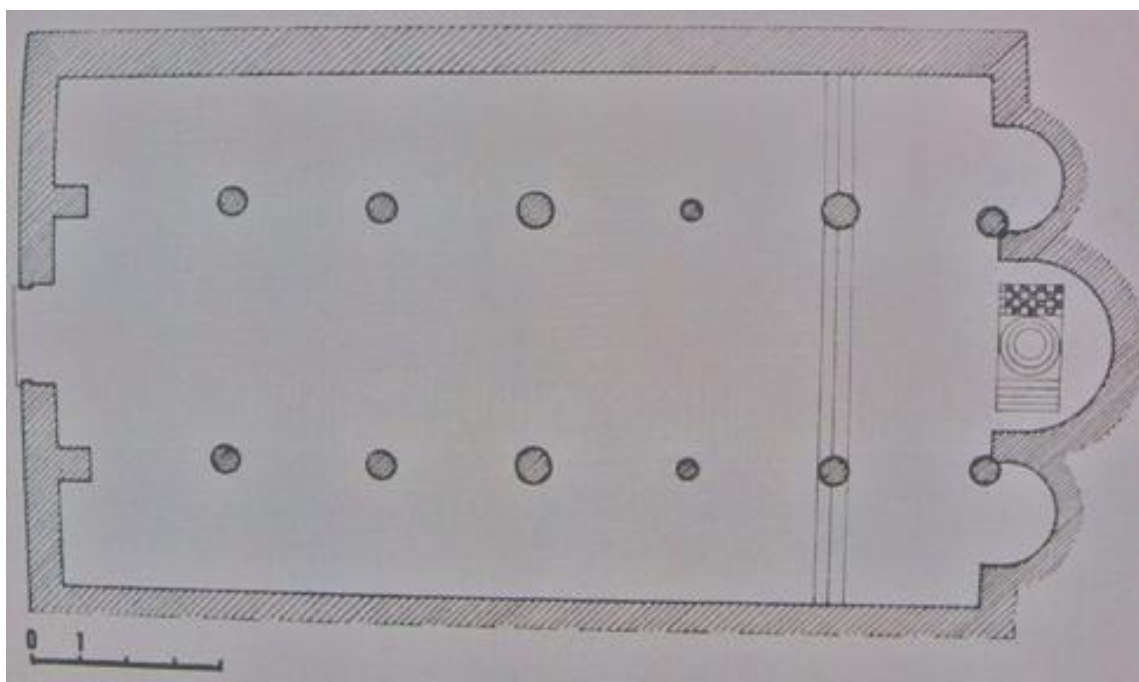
Teano, chiesa di San Benedetto, planimetria da Archivio Diocesano di Teano
